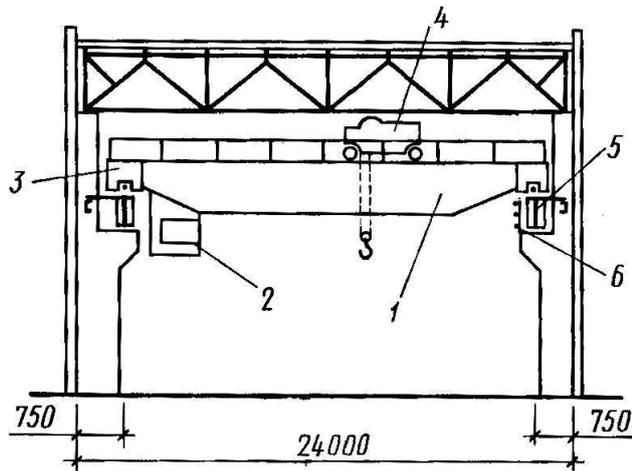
Одноэтажное промздание с мостовыми кранами:
